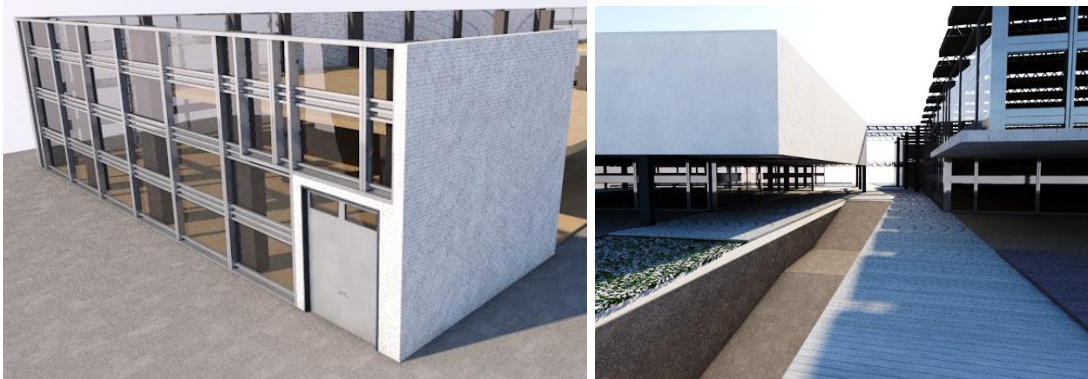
Fachadas Centro Deportivo Industrial T-42
